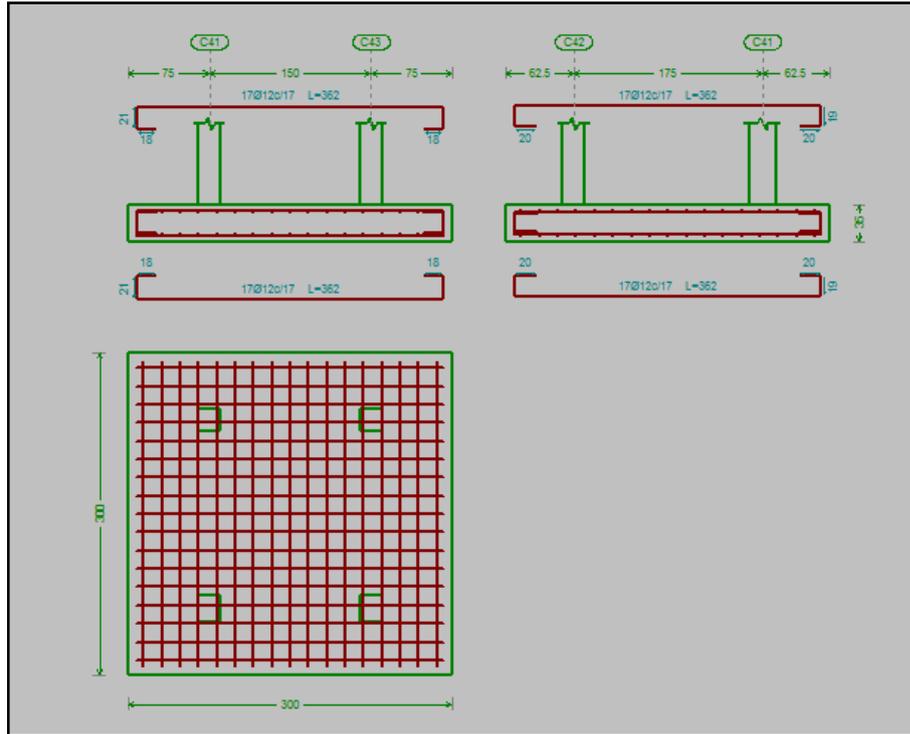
Dimensiones y armadura para zapata de fundación para ascensor.
